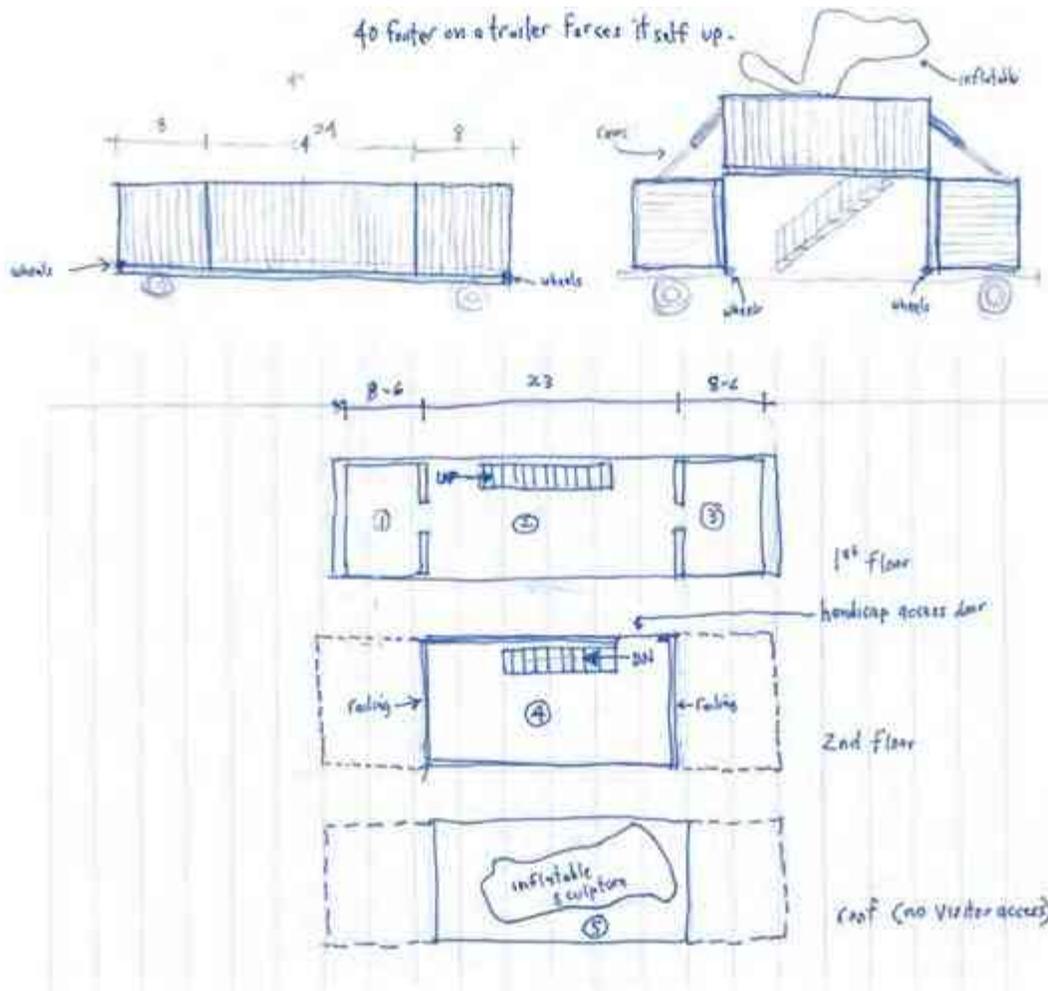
Croquis de Diseño de MuMo. Planta de distribución y alzados.
